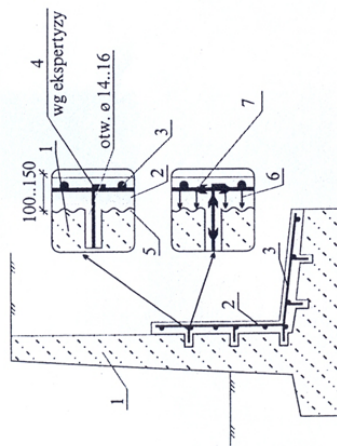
Zapewnienie ciągłości i szczelności zbiorników prefabrykowanych za pomocą betonu ekspansywnego
